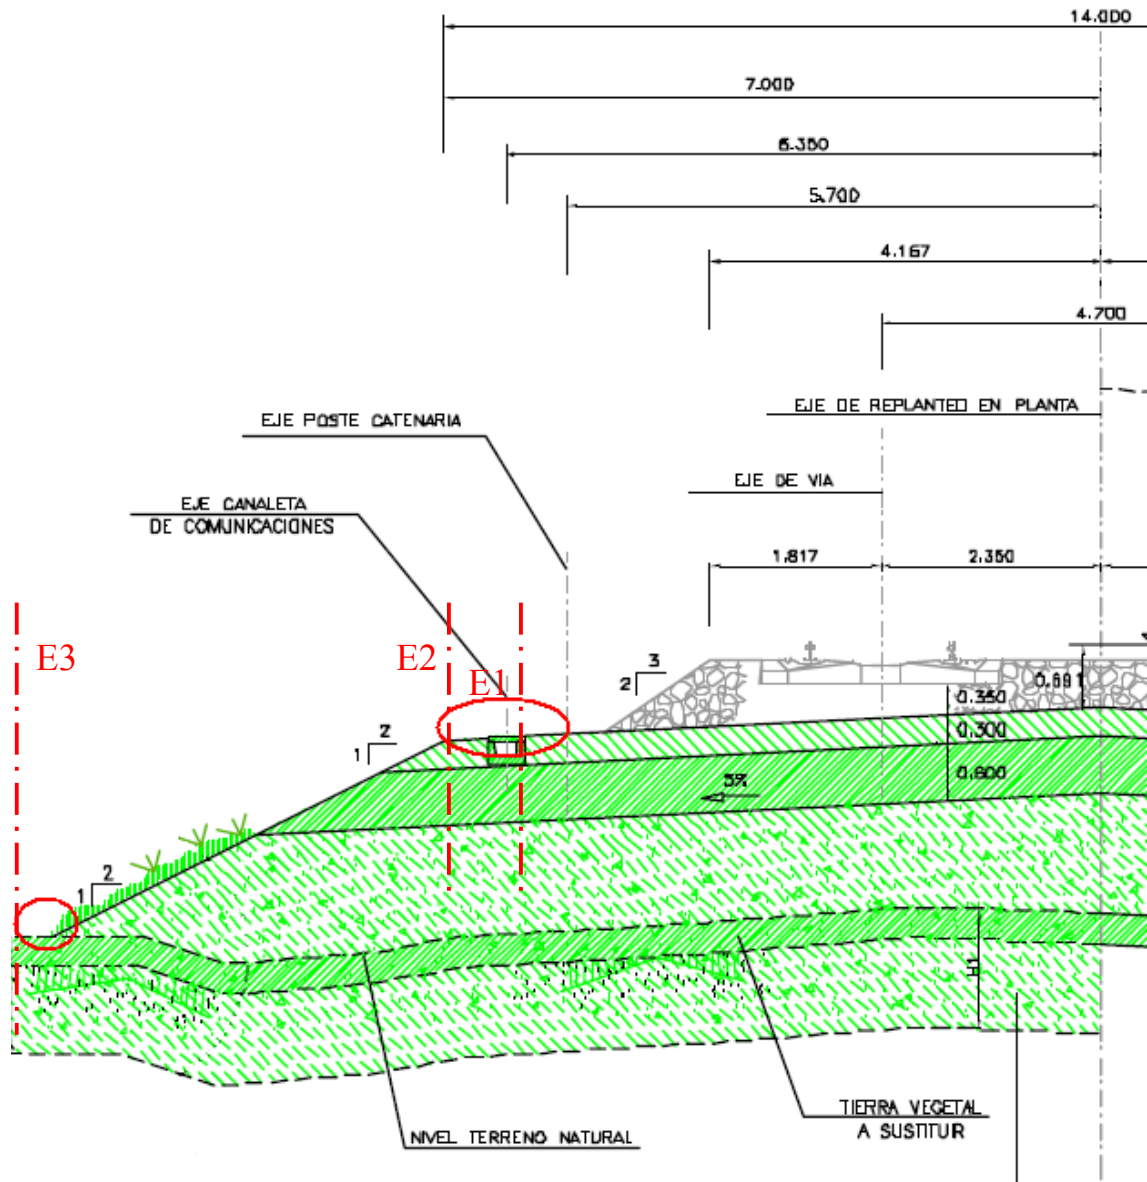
Posibles emplazamientos de las barreras para-viento en estructura de vía sobre terraplén.
